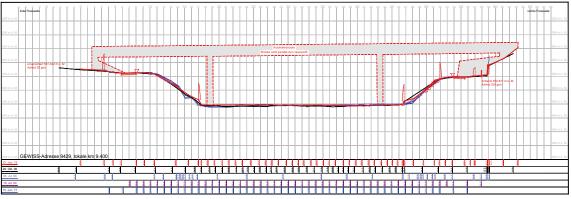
Exemple 1 profil d'espace libre, profil en travers
